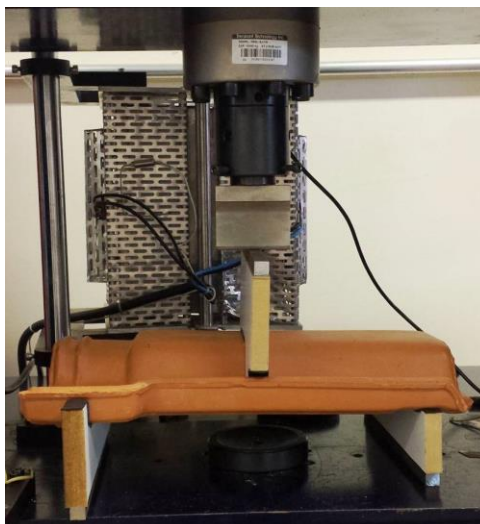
Ilustração do dispositivo para ensaio de flexão simples em telhas cerâmicas do tipo romana.
